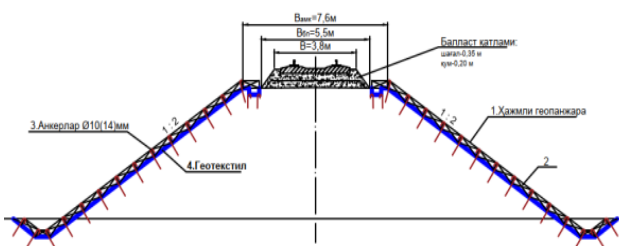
Конструкция насыпи с укреплением геосинтетическими материалами
